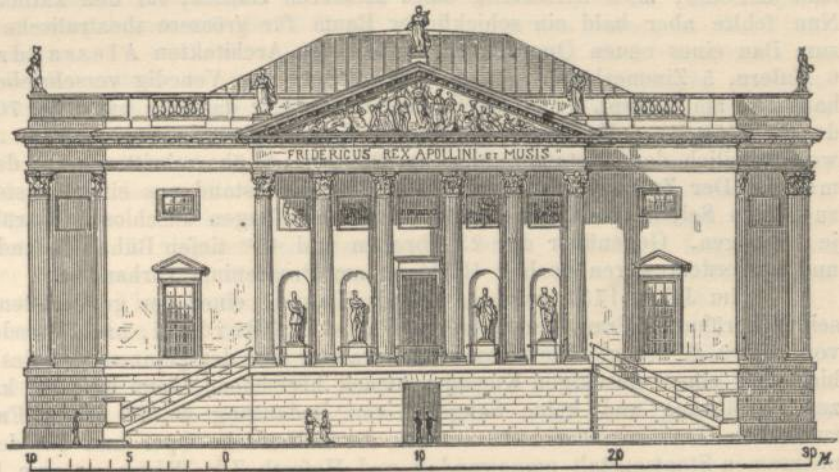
Opernhaus zu Berlin. Hauptfaçade
